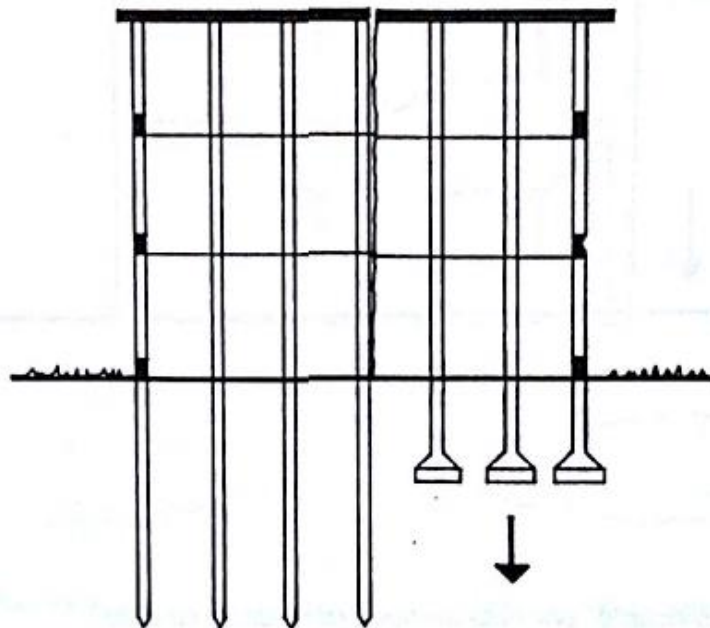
Fissura vertical por deficiência de amarração entremuro e prédio.
